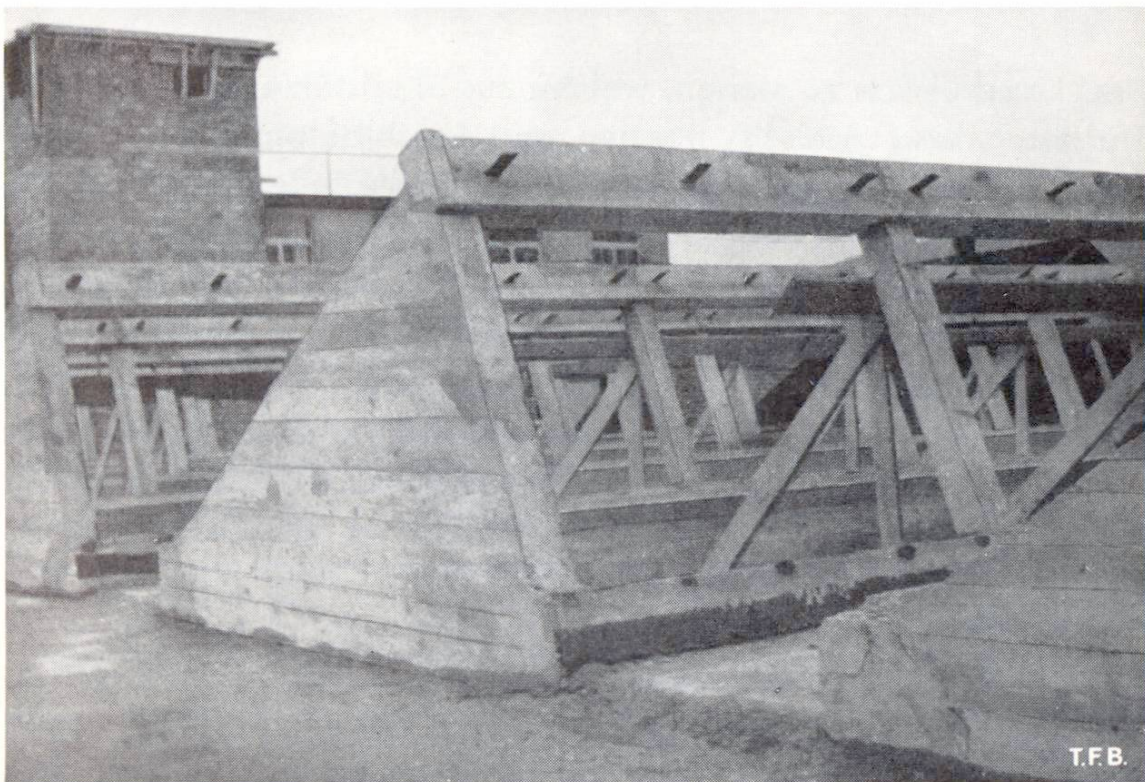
Im Rohbau fertiggestellte Fabrikhalle
